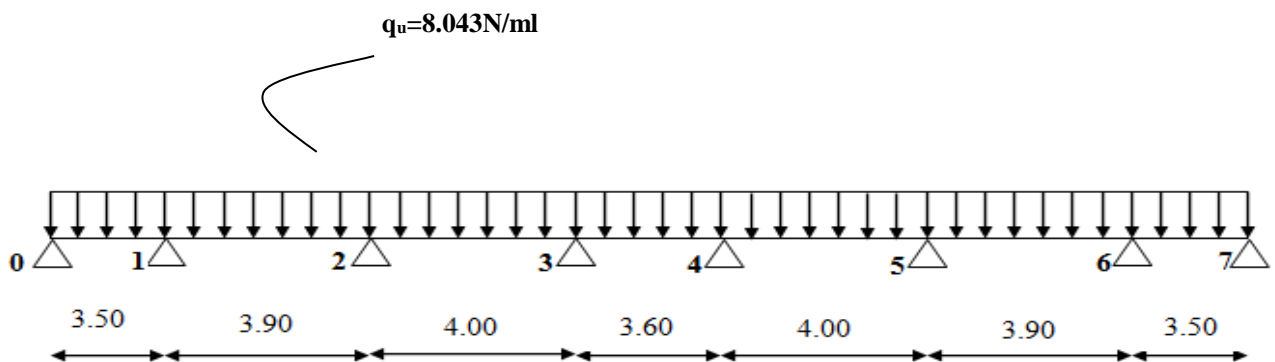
schéma statique de la poutrelle à six travées
